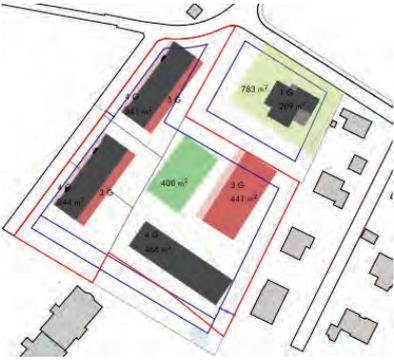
Lösungsvariante mit bestehendem Kindergarten
